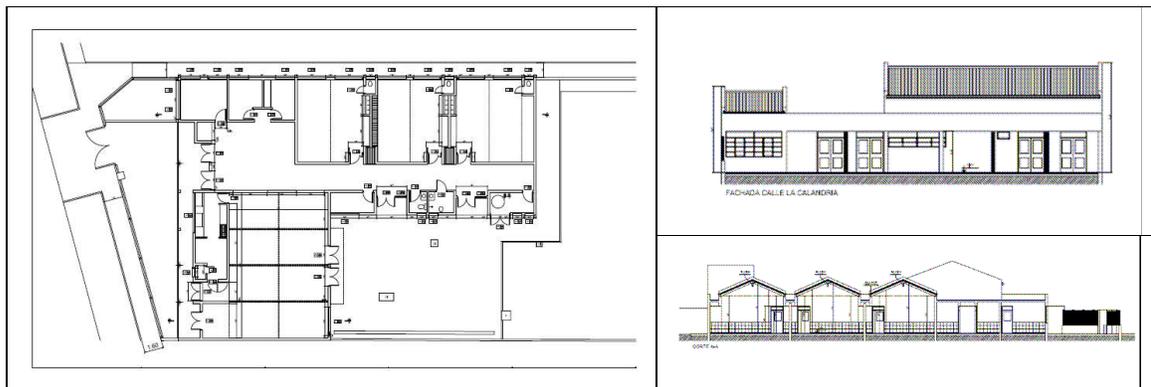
Planta, corte y vistas E. I. Barrio San José.
